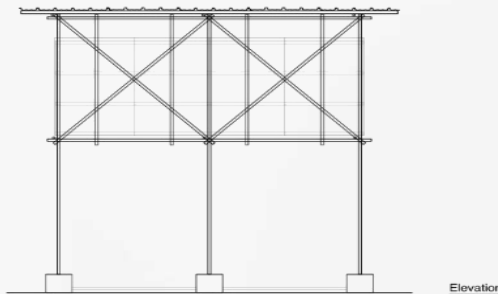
Corte local tipo mercado nai mueang, tailandia
